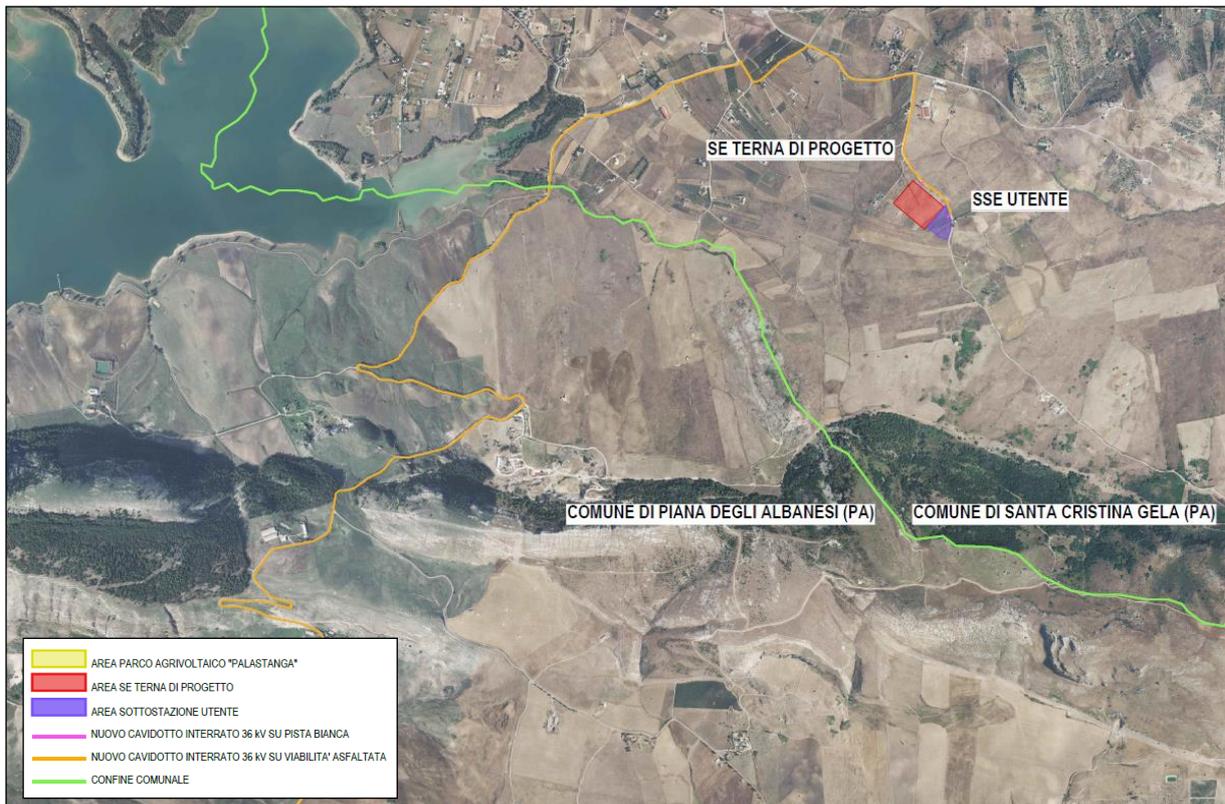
Inquadramento opere in progetto (area stazioni) su Ortofoto (Scala 1:10000)
